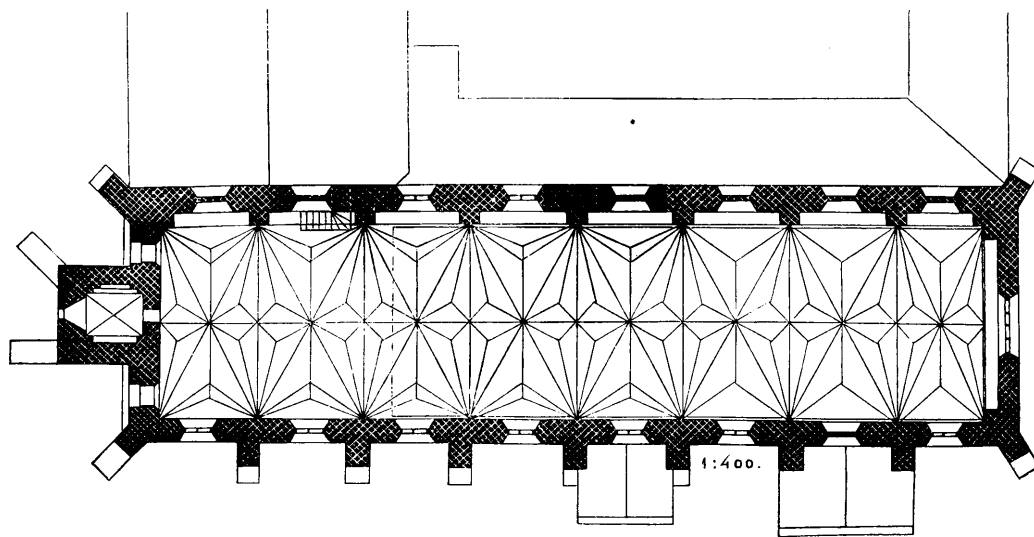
Oberer Grundriss der Klosterkirche in Zarnowitz.
